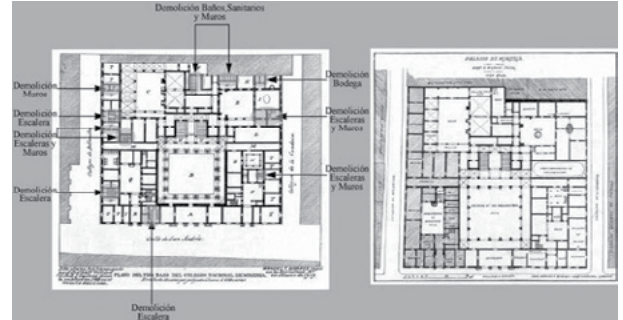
Comparación de las obras realizadas para el año de 1909; a la izquierda el plano de la planta baja levantado por Antonio Villard Olea y publicado en 1841, y a la derecha el plano de la planta baja levantado por Manuel Francisco Álvarez en 1909; se aprecian algunas demoliciones tanto de muros como de escaleras en todo el edificio. José María Castera, “Colegio de Minería. Noticias sobre su origen y erección”, en *El Mosaico Mexicano*, t. VI, 1841, y Manuel Francisco Álvarez, *El Palacio de Minería. Memoria descriptiva*, México, Secretaría de Instrucción Pública y Bellas Artes, 1910. Diseño de Juan Ramón Rodríguez Covarrubias.
